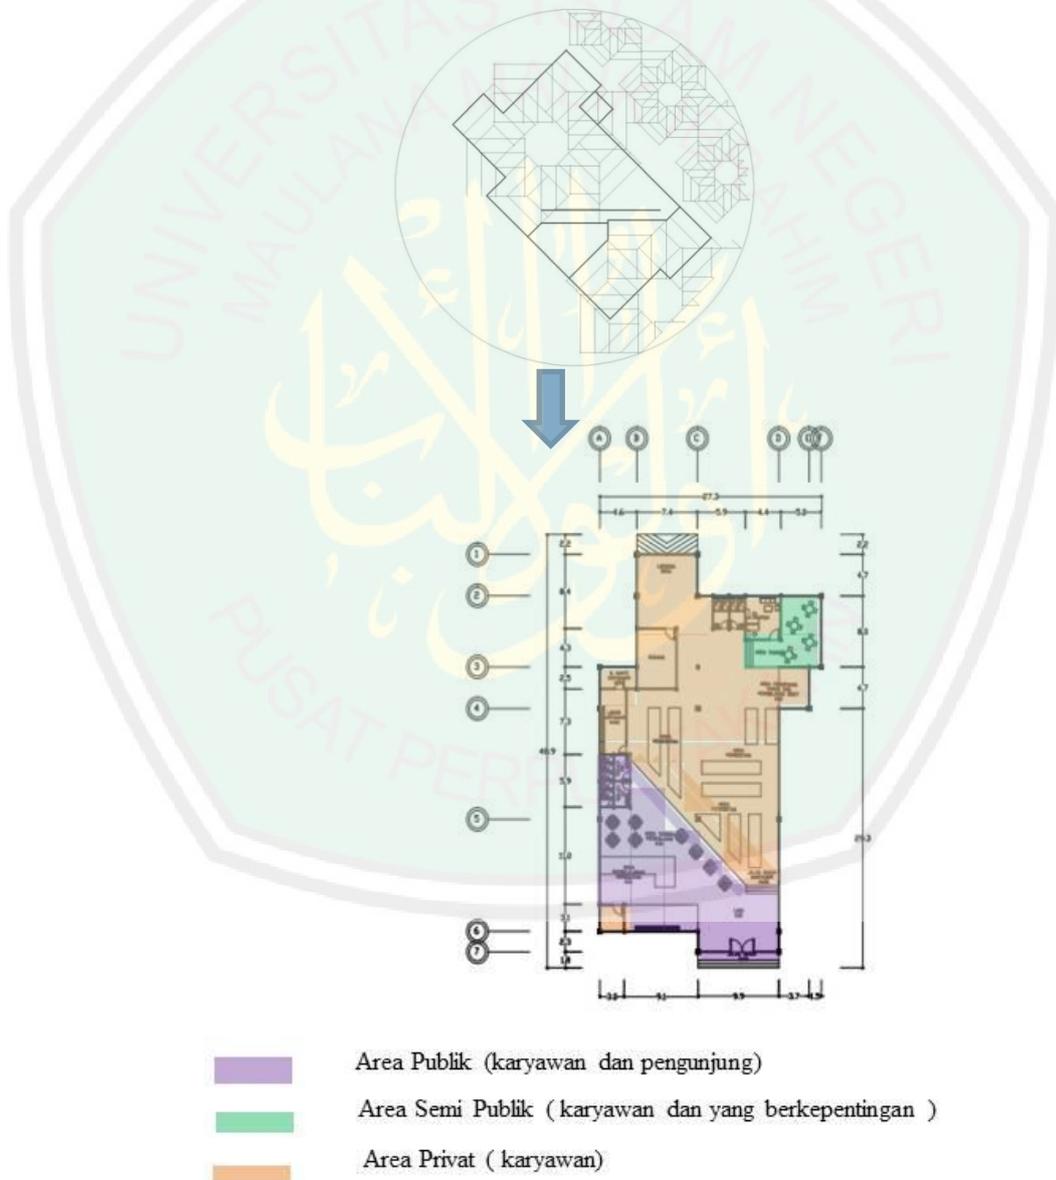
grid pembentuk denah bangunan penjualan dan area pengguna
